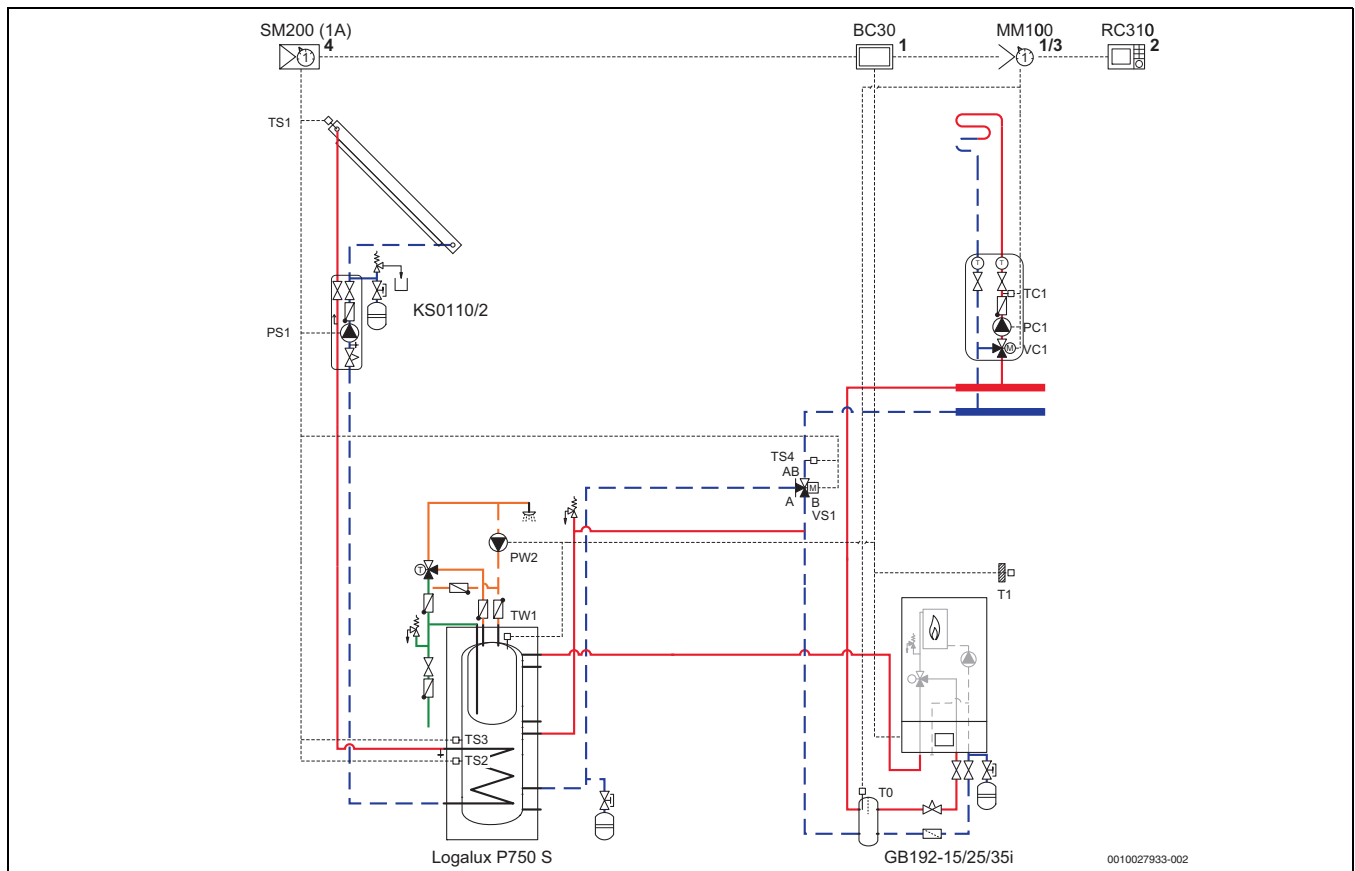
Exemplu de schemă hidraulică cu boiler tanc-în-tanc P750 S conectat la o instalație solară și un echipament de încălzire montat pe perete
